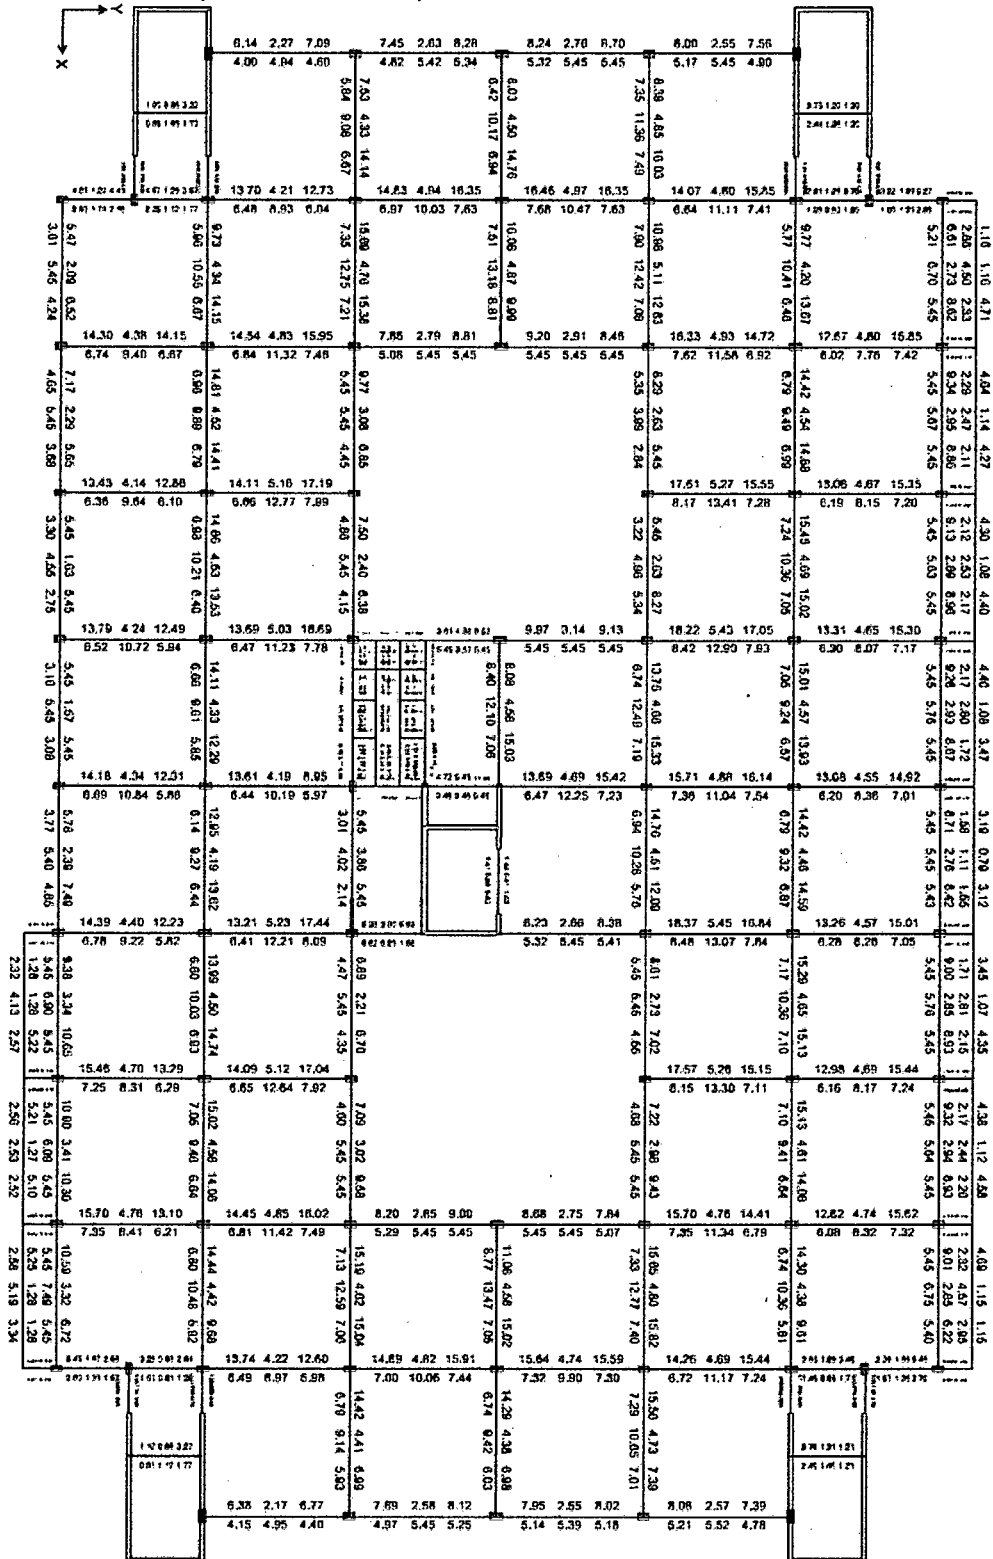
, Estructura aislada, Verificación de elementos estructurales – Piso 3.
